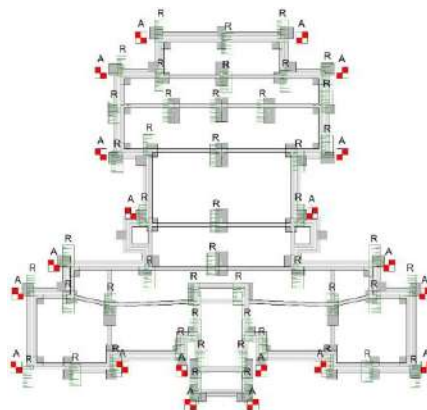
Instrumentação instalada no edifício no âmbito do plano de instrumentação e observação.
